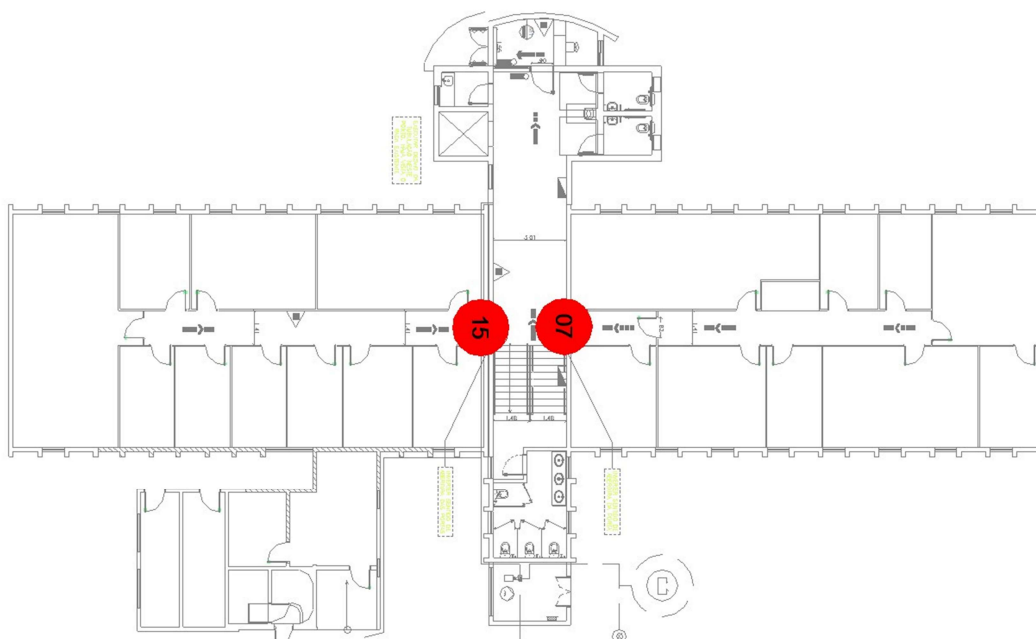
Planta térreo Prédio da PG/SG/Consu
